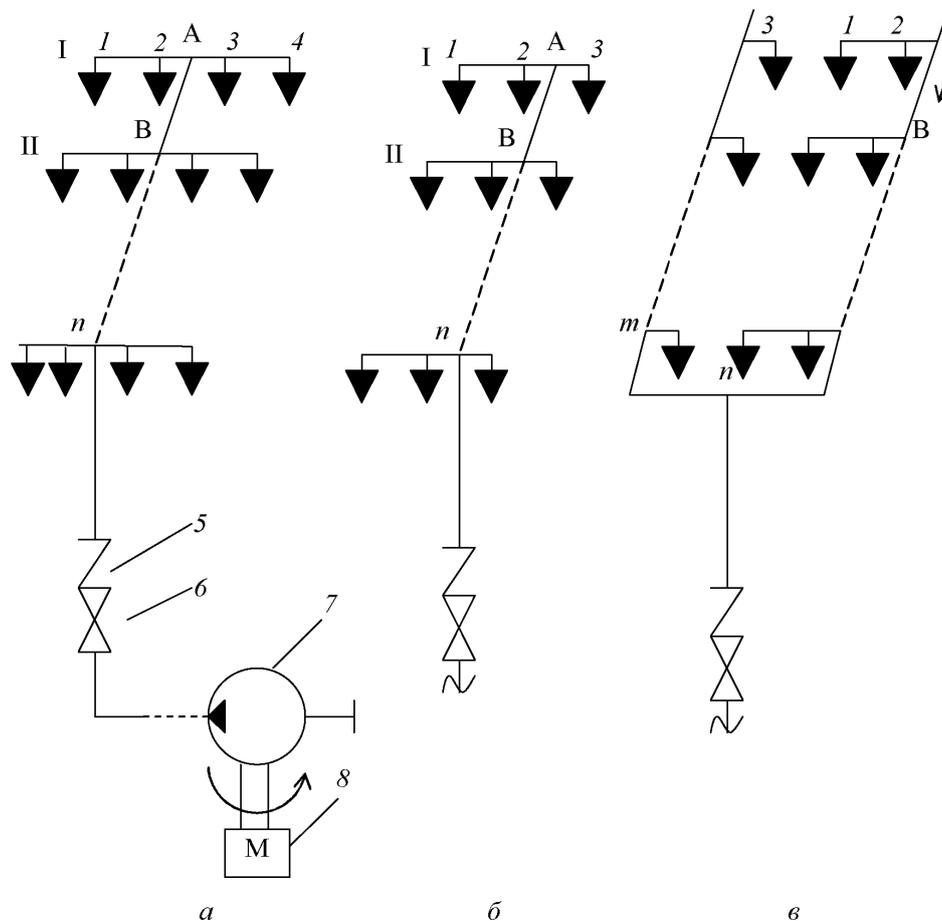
Расчетные схемы водяных установок пожаротушения:
